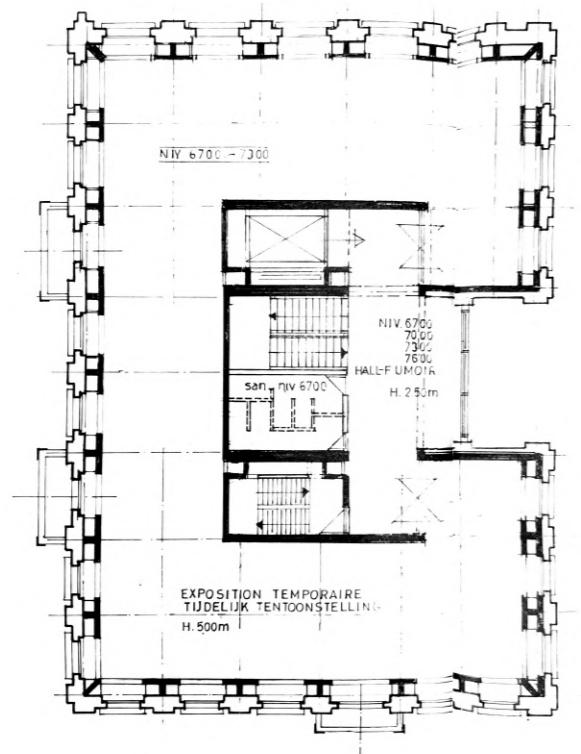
Plan type d'un étage, définitive de la phase II.
